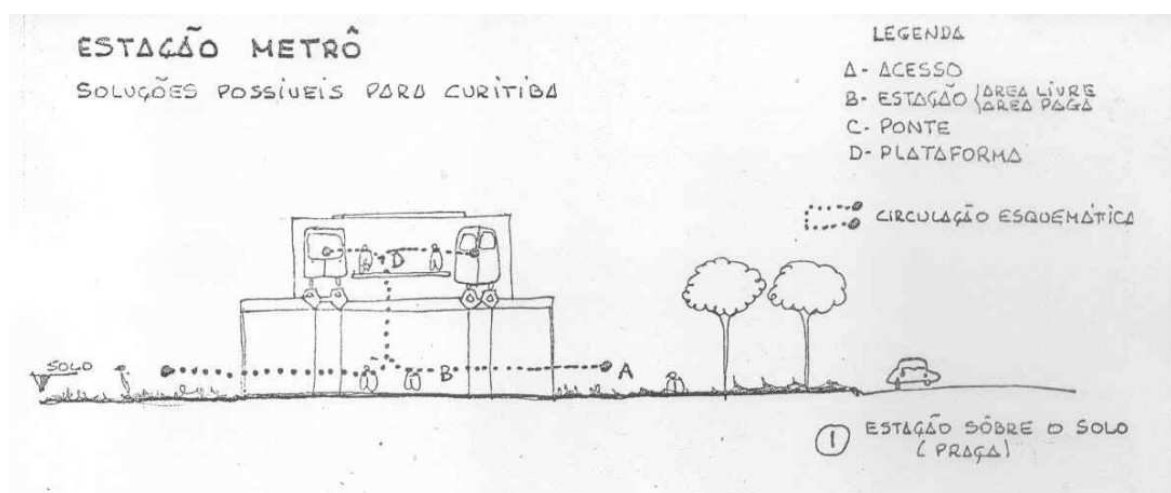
Plano Preliminar do Metrô - estação sobre o solo
